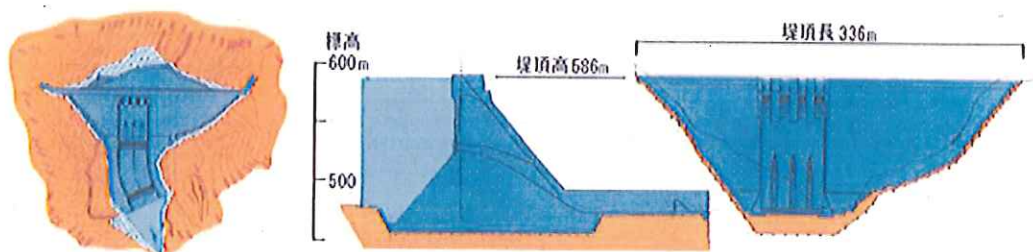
ハッ場ダムの平面図・標準断面図・下流面図 (出典: ハッ場ダム工事事務所HP)
